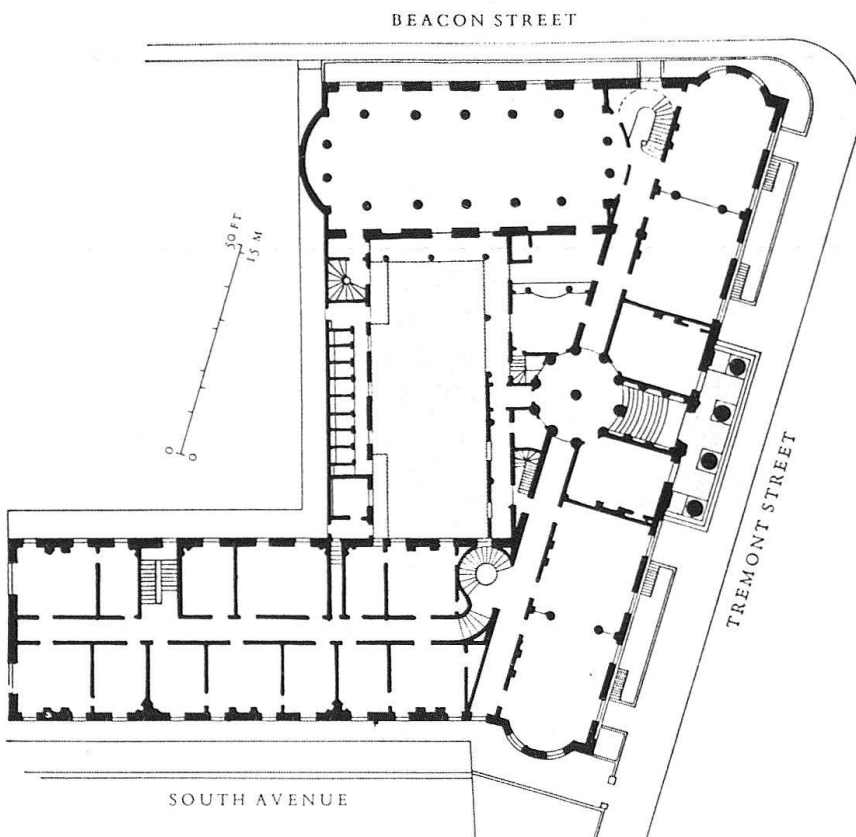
Boston. Plan schématique du Tremont House (rez-de-chaussée)
